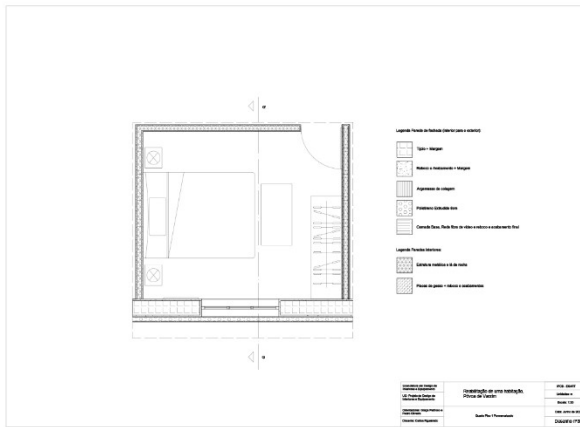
Planta Pormenorizada Quarto Habitação Piso 1. Fonte: Autor.
